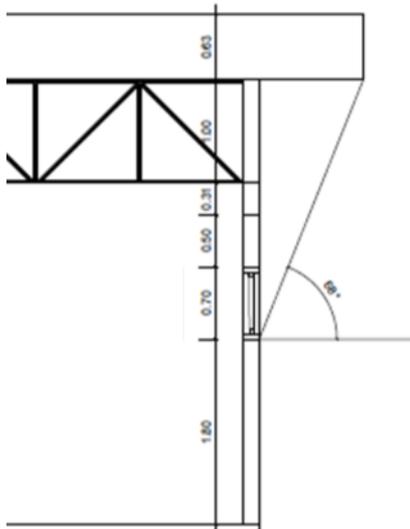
Intervalo horário da fachada sul – melhor cenário.
